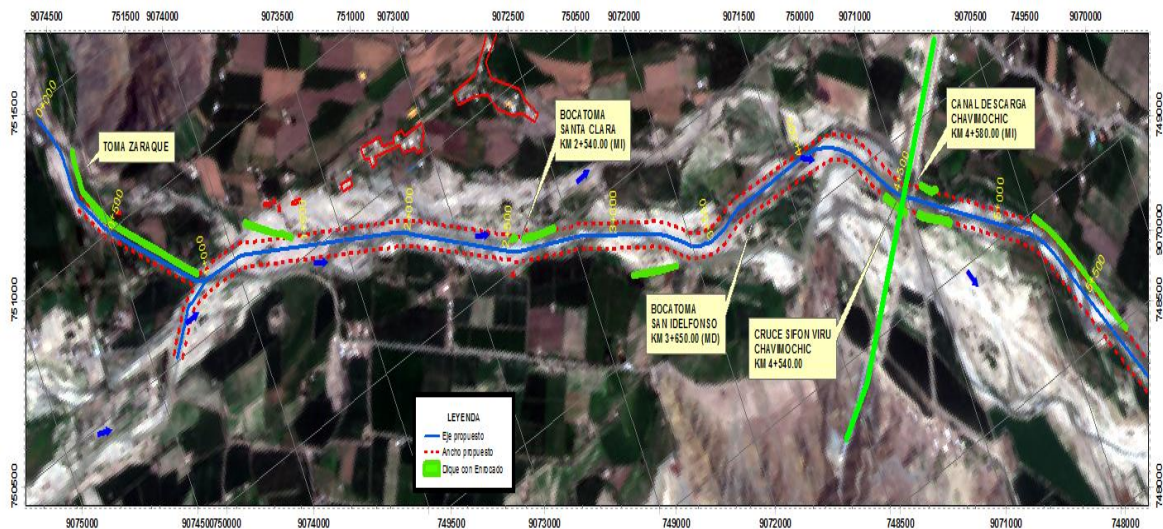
Estructuras de protección existente en el río Virú Km 5+500 - 10+940
